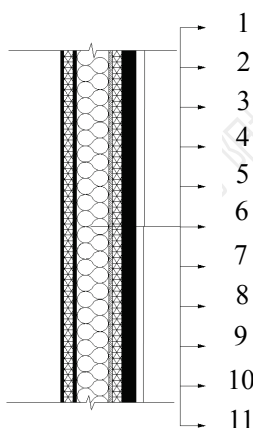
墙体的外围护构造（外墙面：湿式做法）
